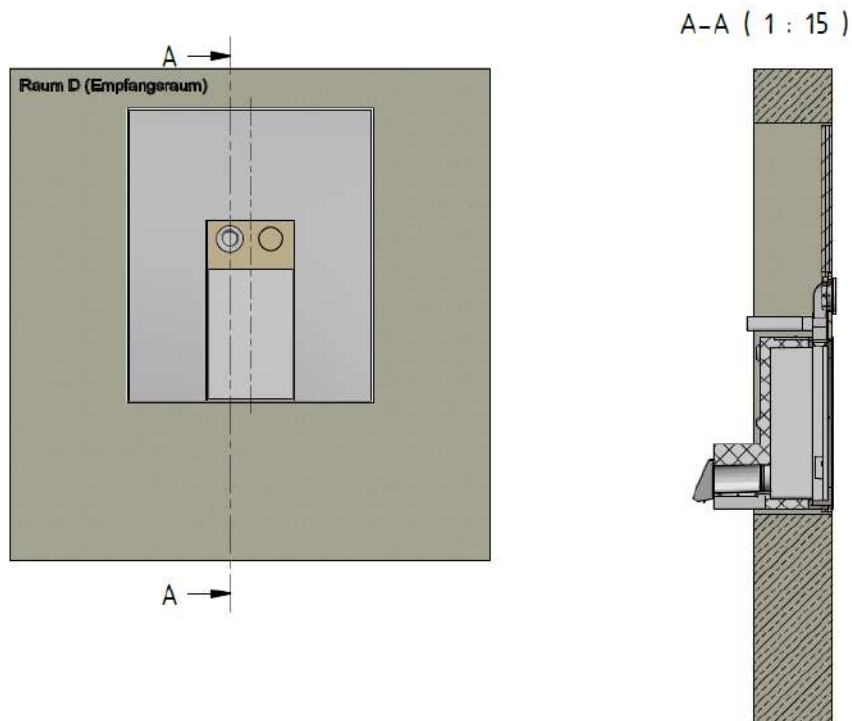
Prüfvariante mit Kanalanschluss ZUL-seitig: Innenansicht und Vertikalschnitt des Prüfaufbaus.
